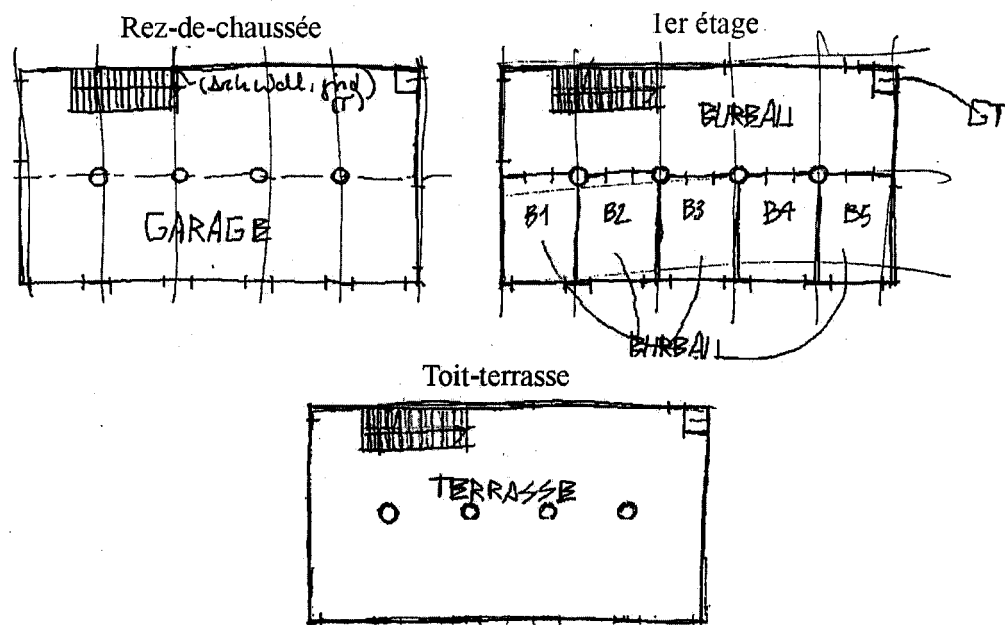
Esquisses architecturales d'une caserne de pompiers
